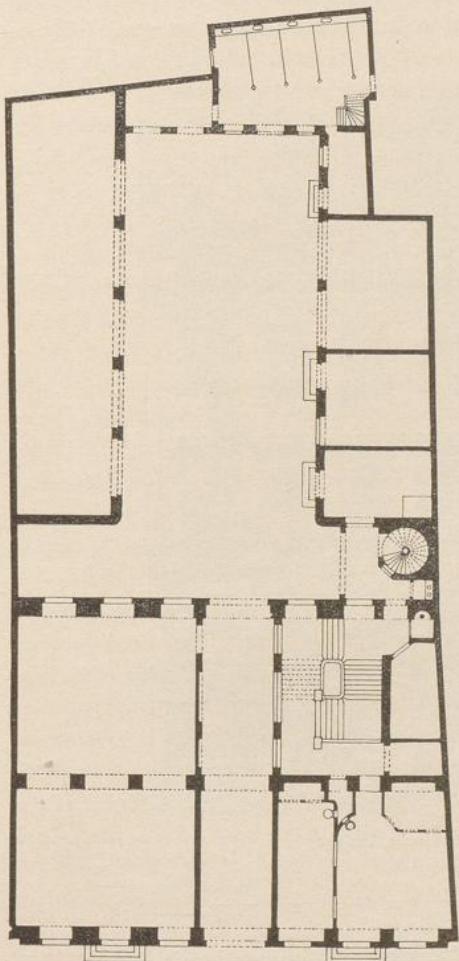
Grosser Korb; Grundriss des Erdgeschosses.
